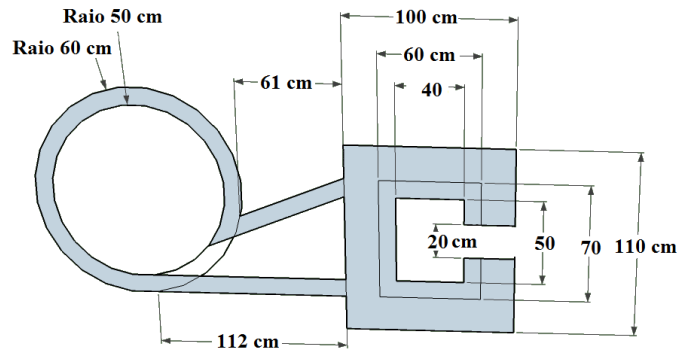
Planta baixa da fornalha a lenha com combustão descendente.
